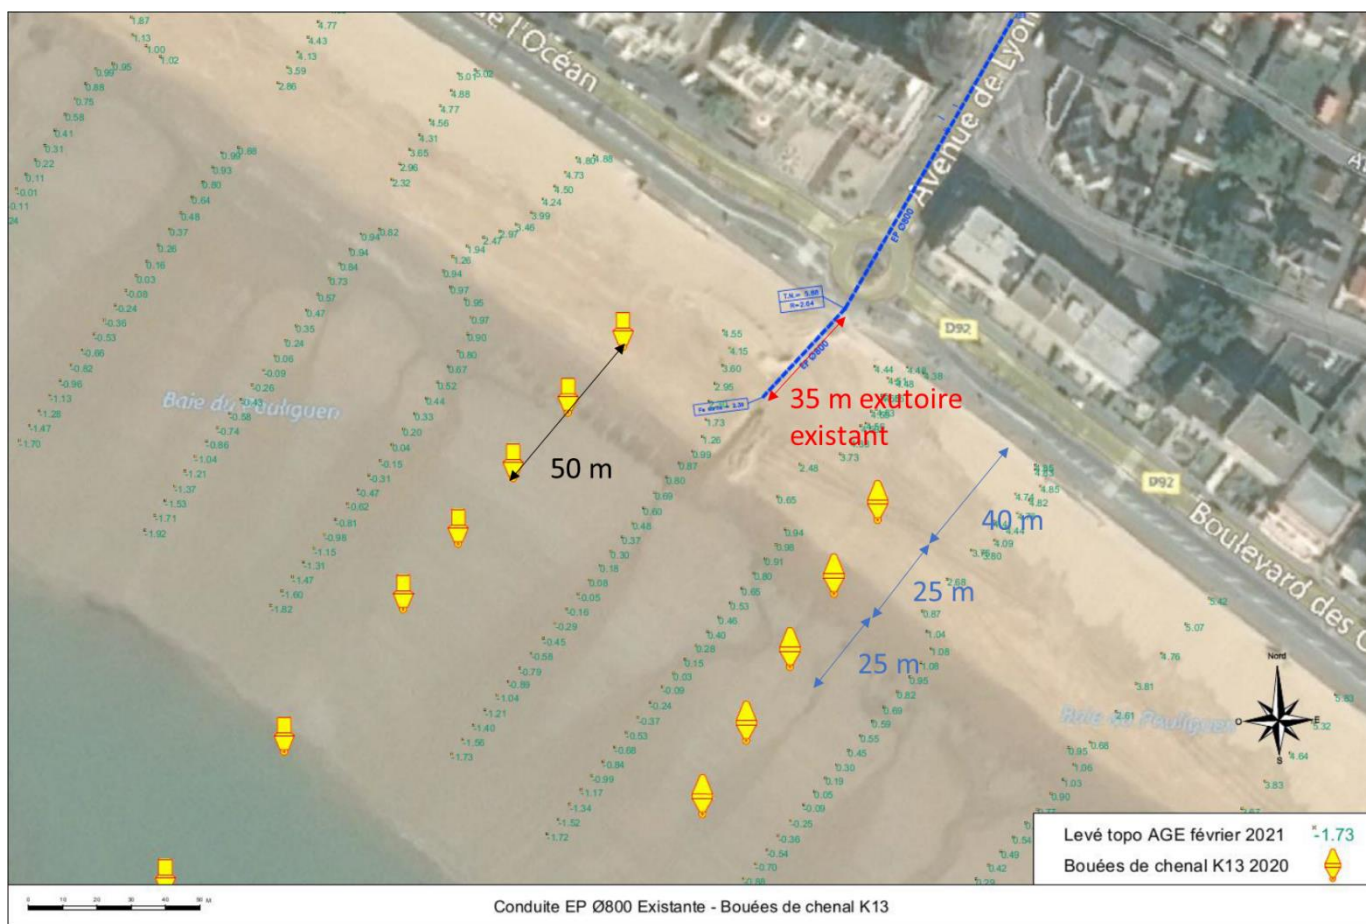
Vue en plan de l'émissaire prolongé et chenal de Kite-surf
